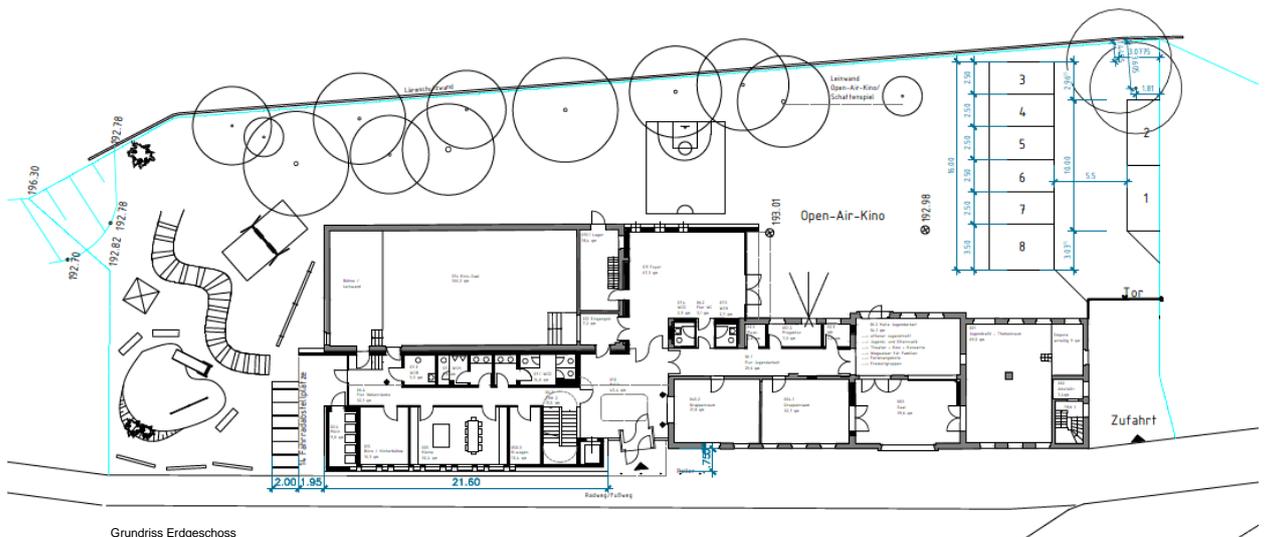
Grundriss Erdgeschoss (Quelle: Stadt Würselen)
